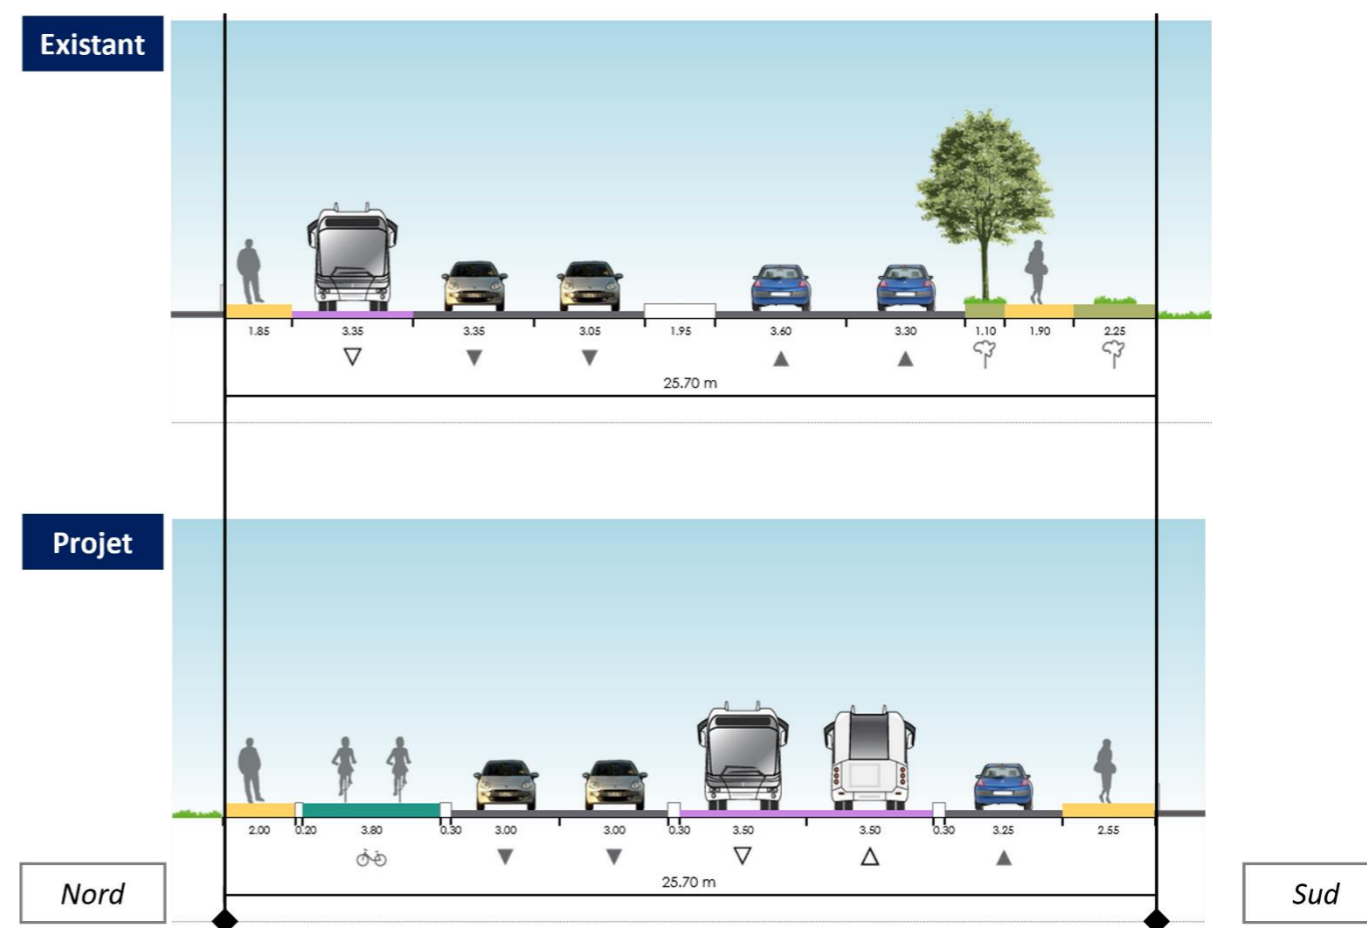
Séquence 4.2 – Avenue du Général de Gaulle Ouest Coupes existant et projet BBM – Coupe n°NSM-030 (section courante)
